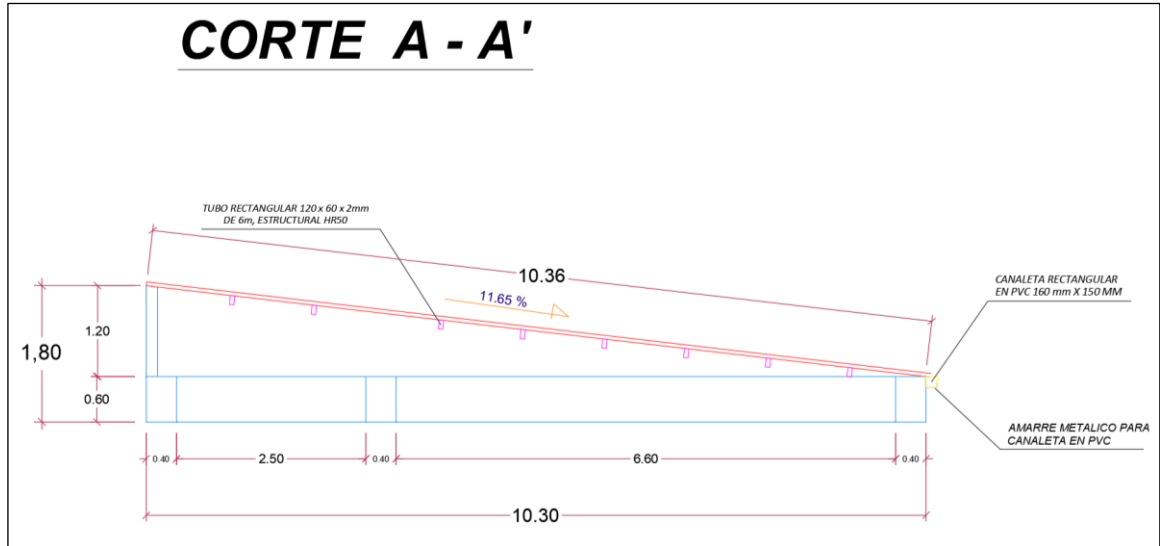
Corte arquitectónico A-A, de la estructura 3 del Centro de Desarrollo Infantil.
